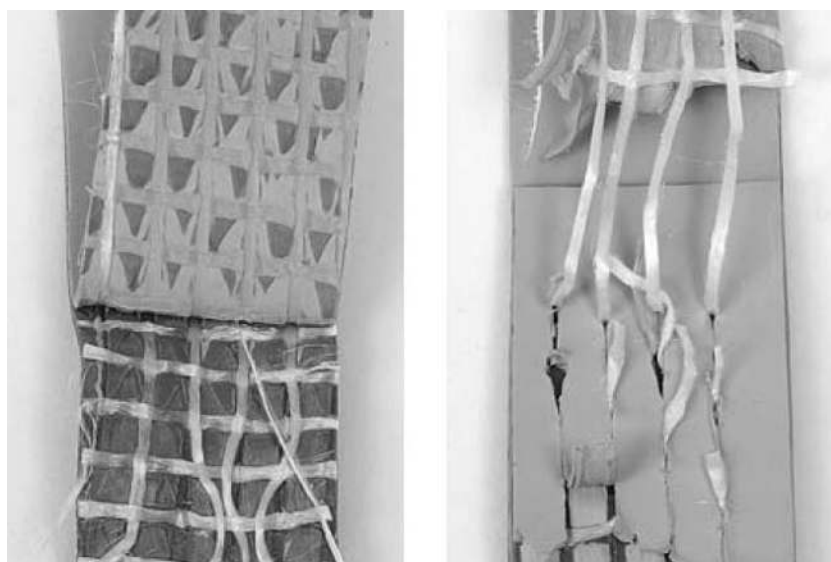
Область сварки ПВХ-мембран
